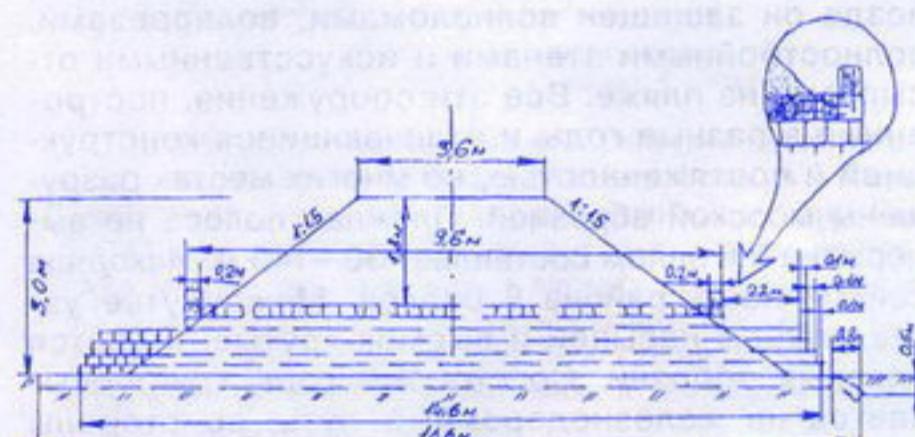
Поперечный разрез водопропускной трубы из геоячеек «ПРУДОН-494»
